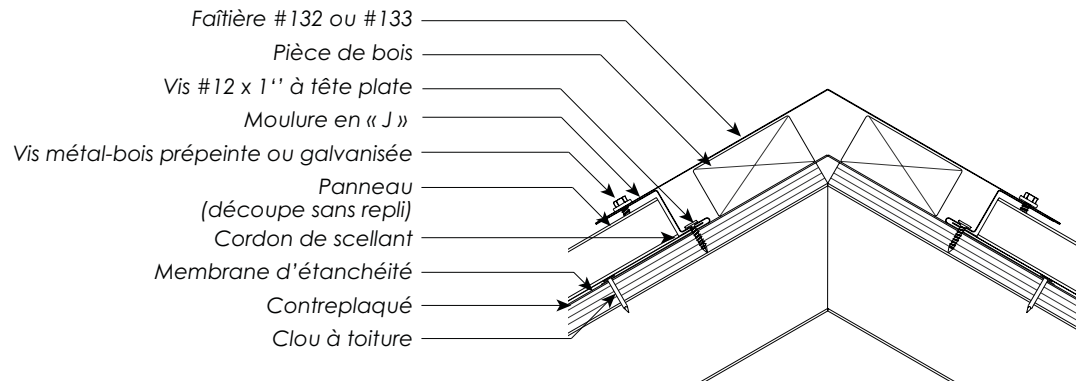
e | Vue en coupe de la faîtière – méthode 3
